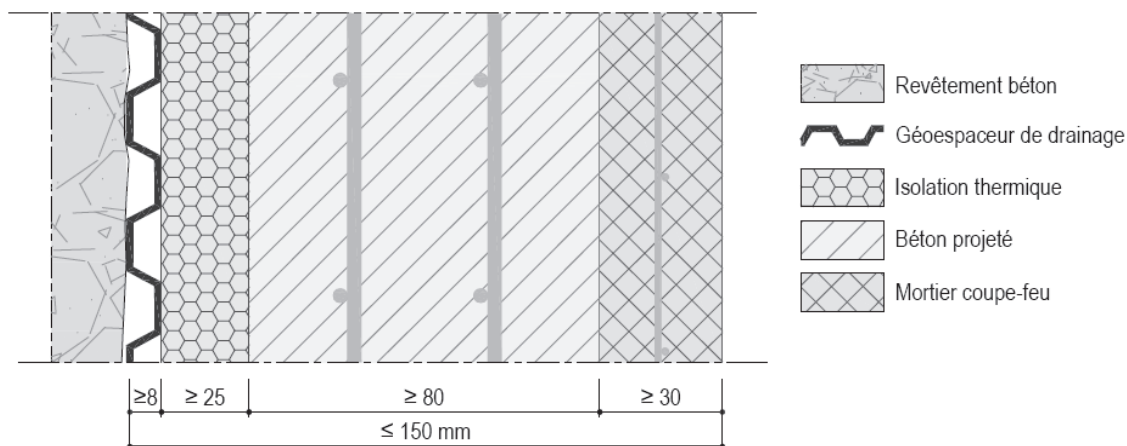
Composition du complexe de drainage hors gel du tunnel Maurice Lemaire
